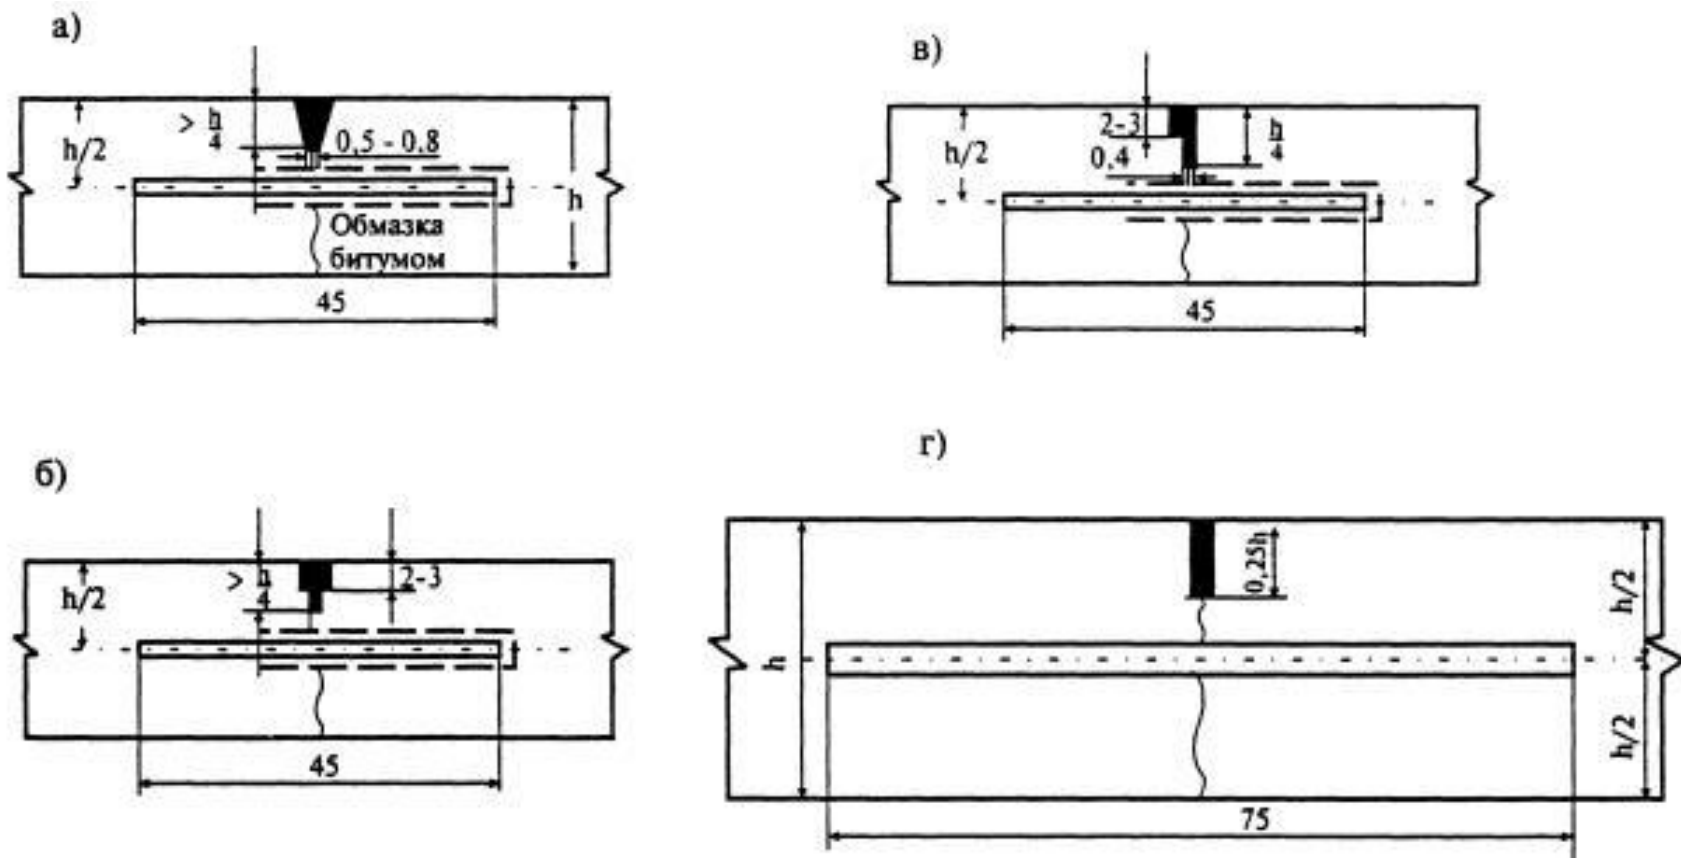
Конструкции поперечных швов сжатия и продольного шва:
